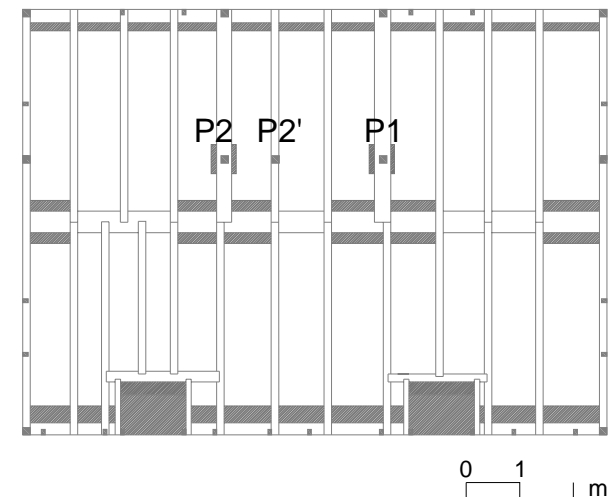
Planta de basamento. Dibujos de la autora.
